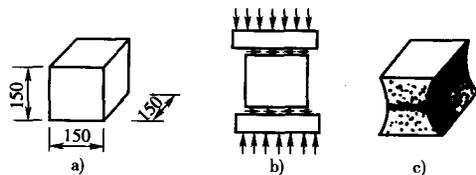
混凝土的抗压强度试验(尺寸单位: mm)
